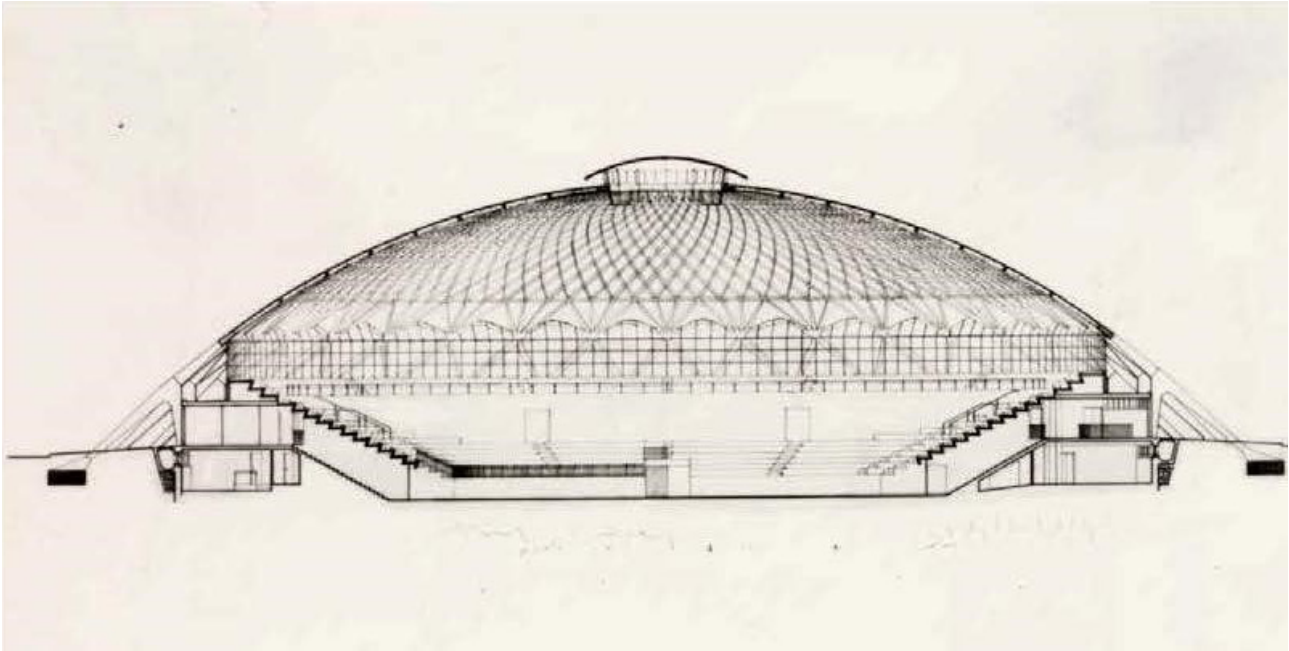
Archivio Pierluigi Nervi, Palazzetto dello sport, sezione. Roma 1960 (MAXXI_Museo nazionale delle Arti del XXI secolo. Collezione MAXXI Architettura).
